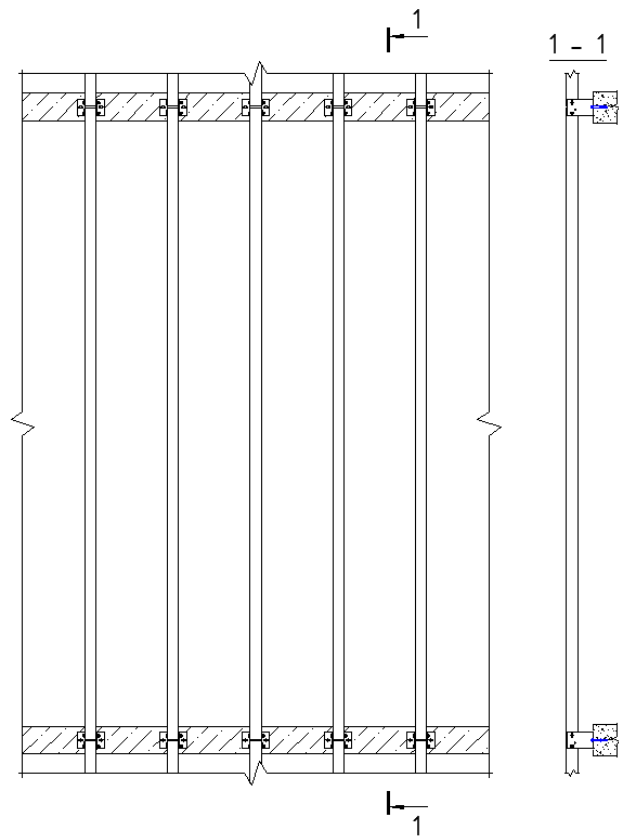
Система крепления в межэтажные перекрытия на основе квадратного профиля
